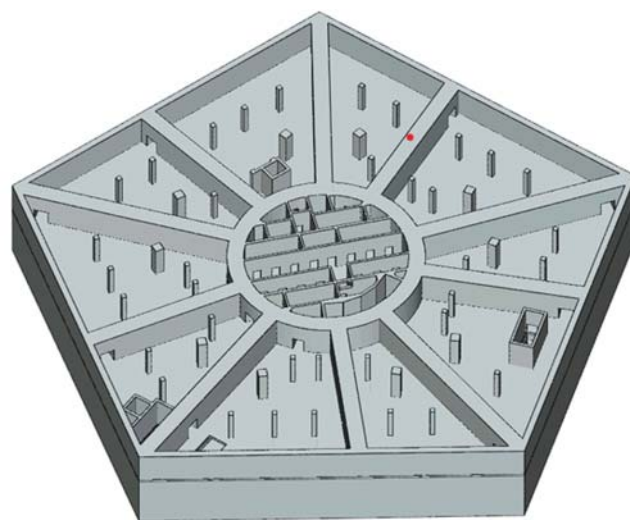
Фрагмент схемы. План минус второго этажа здания
